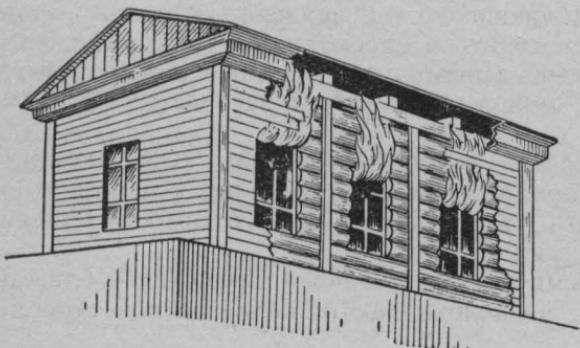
Скрытое распространение огня под наружной обшивкой бревенчатого здания
